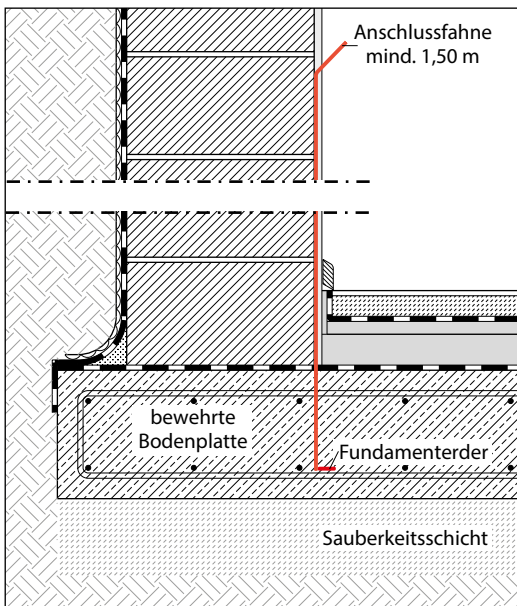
Ausführung des Fundamenterders im bewehrten Fundament
